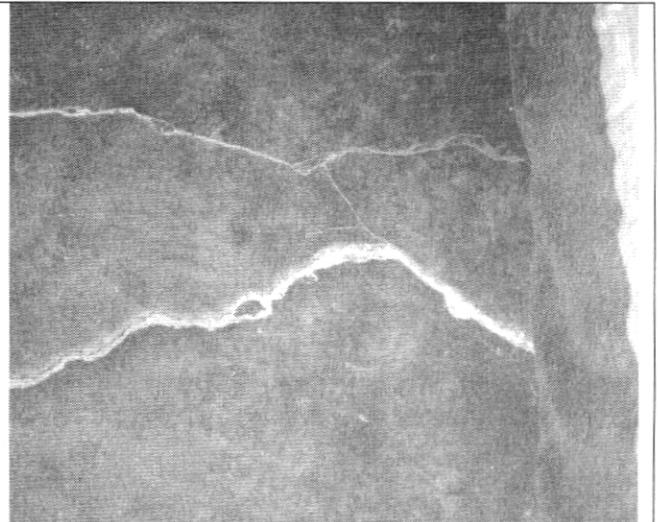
Se observan grietas continuas en los pisos con aberturas de 2 cm aproximadamente
